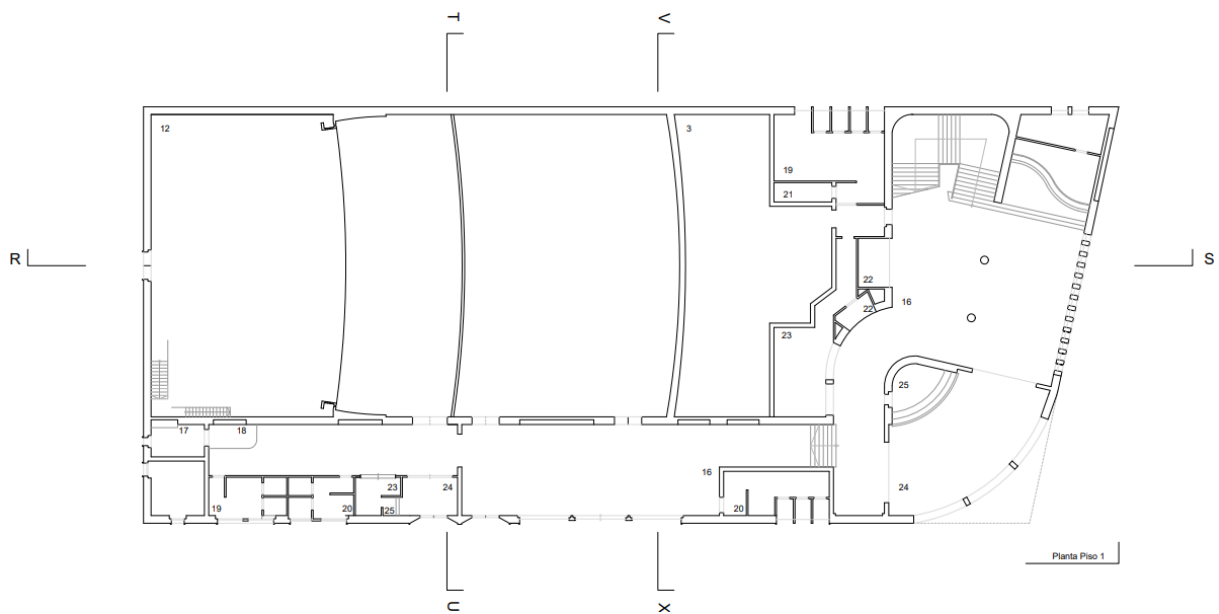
Planta do existente do Cinema de Arrifana, 1º piso.
